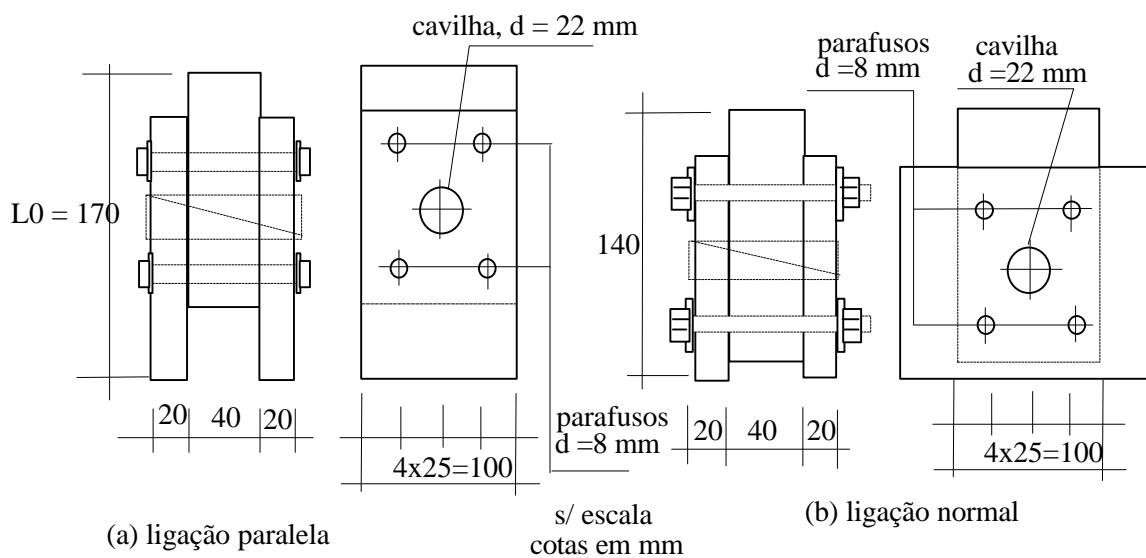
Corpos-de-Prova de Ligações Cavilhadas e Parafusadas
